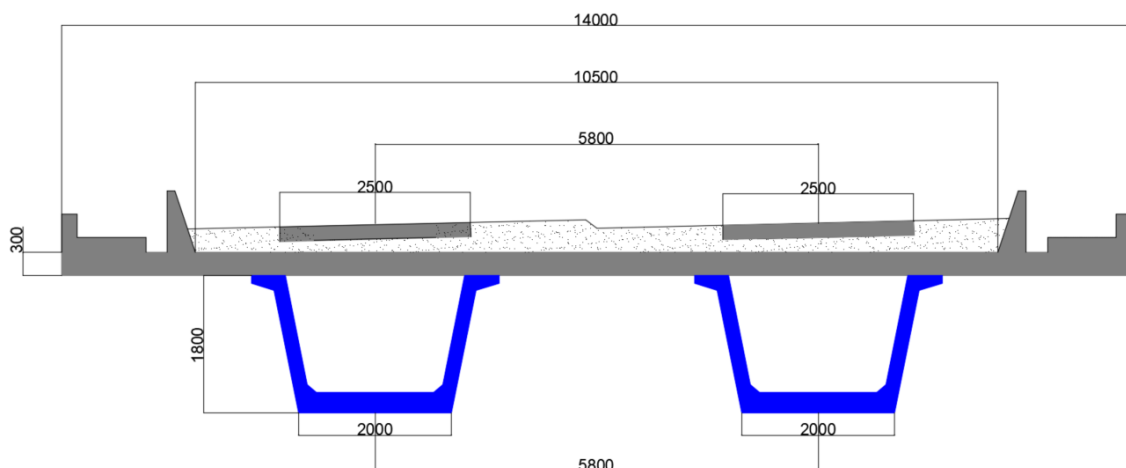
3 – Geometria da secção do tabuleiro (mm).
